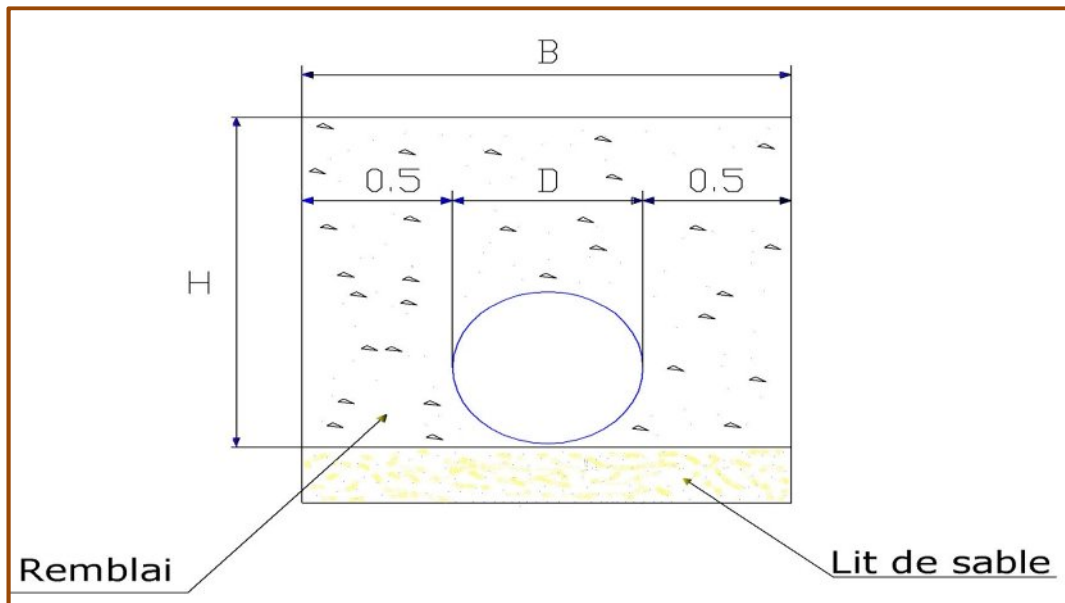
Coupes en travers de la tranchée de la conduite.
